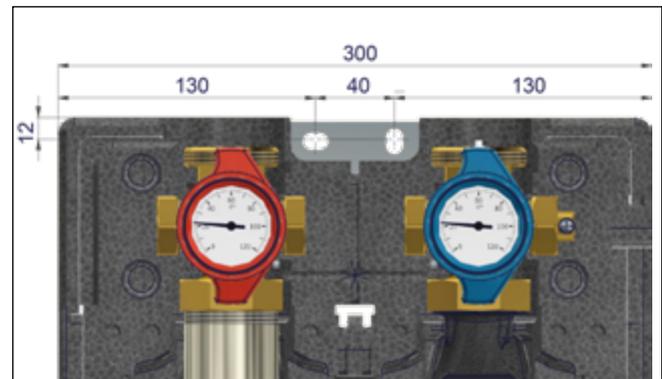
Montageskizze KLSC25 und KLSC32
